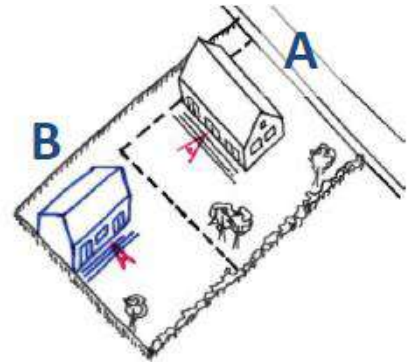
Exemple d'implantation possible, prenant en compte les vis-à-vis avec les constructions existantes en front de rue
